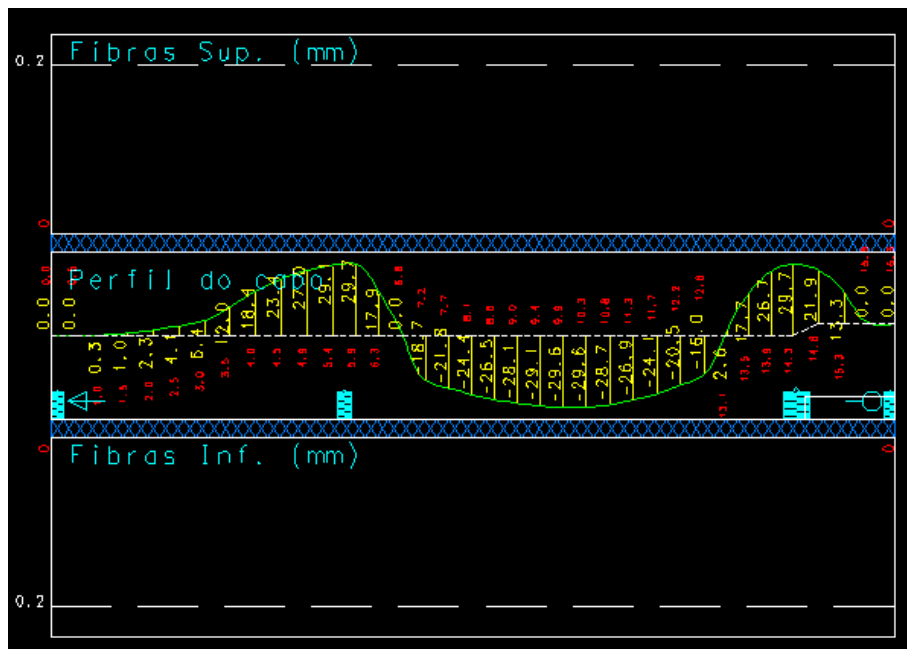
Fissuração viga V8 do subsolo (CAD/TQS)
